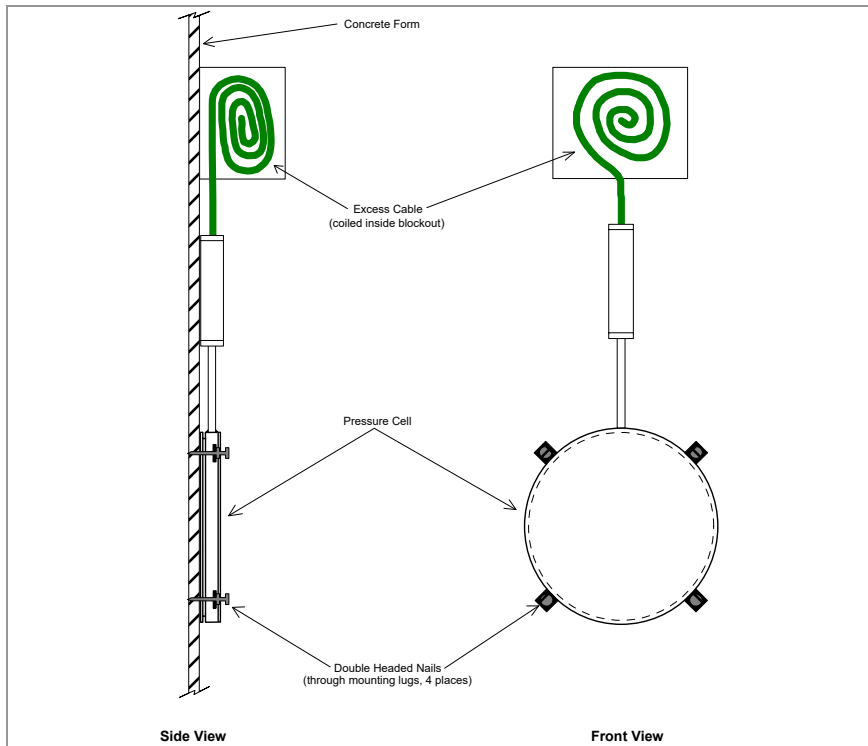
Fijación del modelo 4810 al encofrado de concreto
